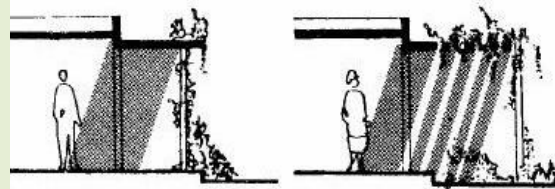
Protección Caminamientos. Fuente: Arquitecto David Morillón Gálvez.
